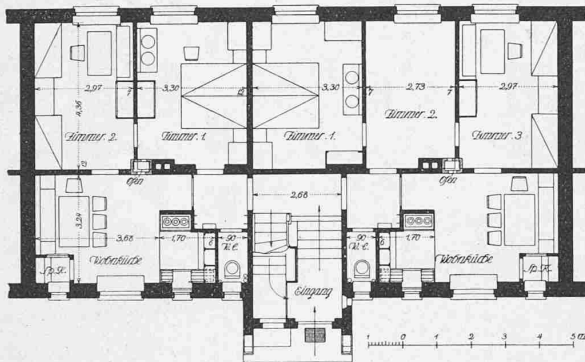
und 9. Grundriss und Schnitt der Kleinwohnungshäuser an der Bertastrasse in Zürich. — 1:200.
